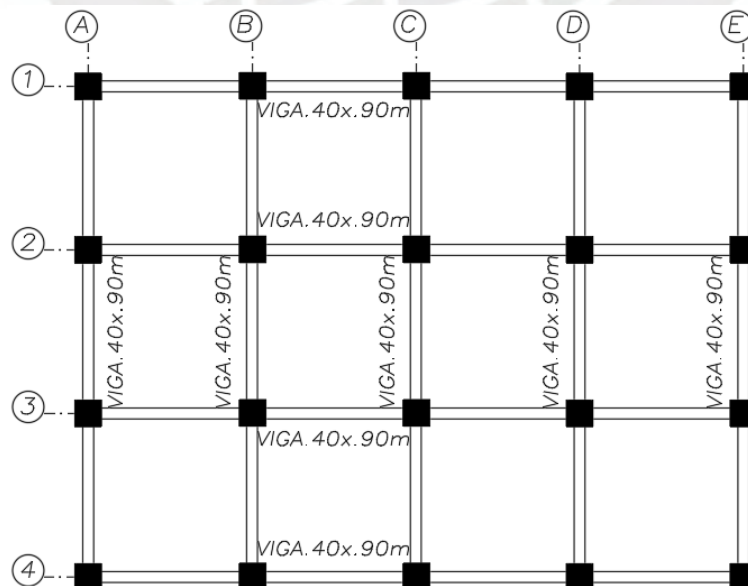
Dimensiones de vigas de la interfaz de aislamiento.
